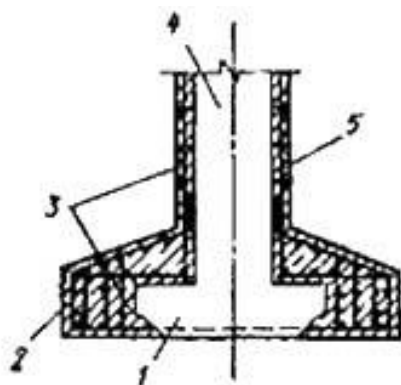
Усиление фундаментов железобетонной «рубашкой»:
